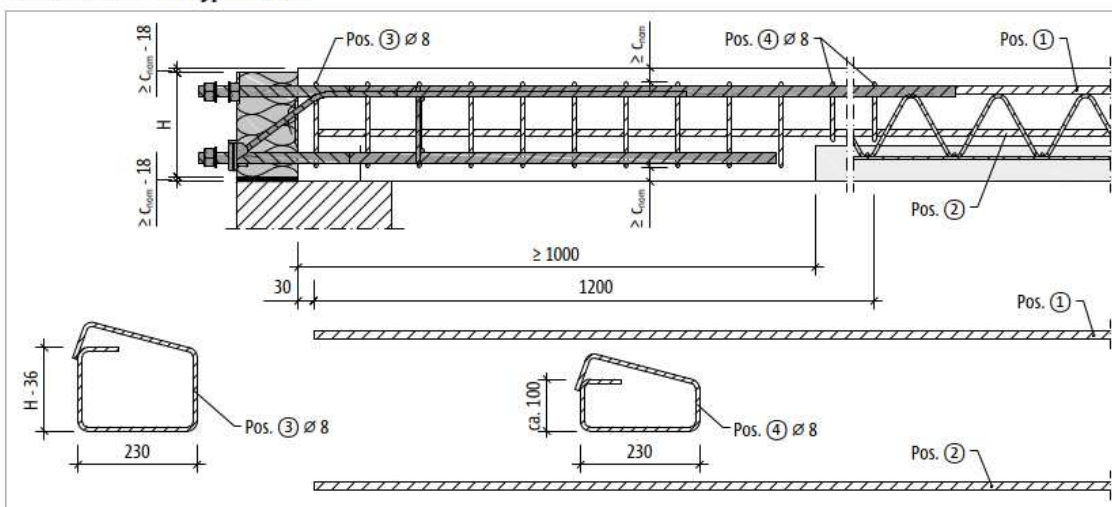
Schöck Isokorb® XT Typ SK-MM2: Bauseitige Bewehrung bei Halffertigteilbauweise mit Bügel \varnothing 8 mm; Schnitt
